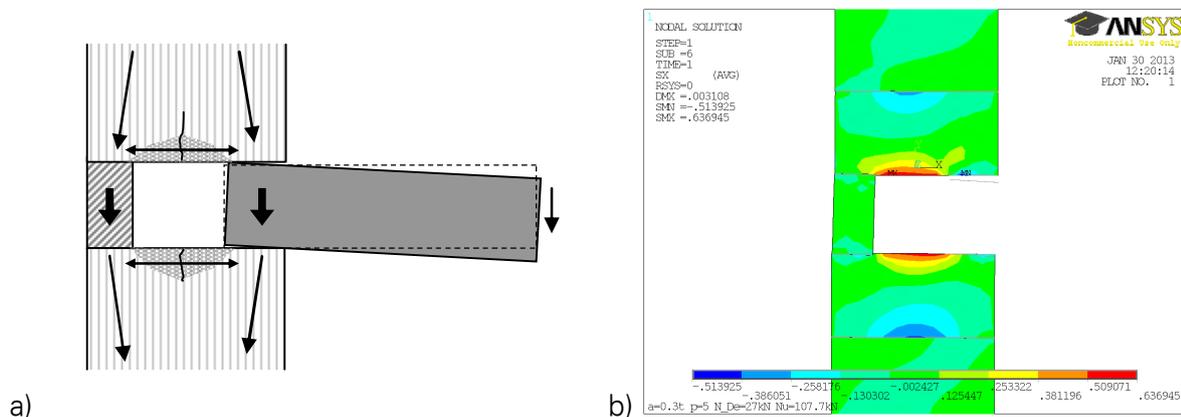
Mechanische Beanspruchung des Wand-Decken-Knotens mit verringertem Deckenaufleger
